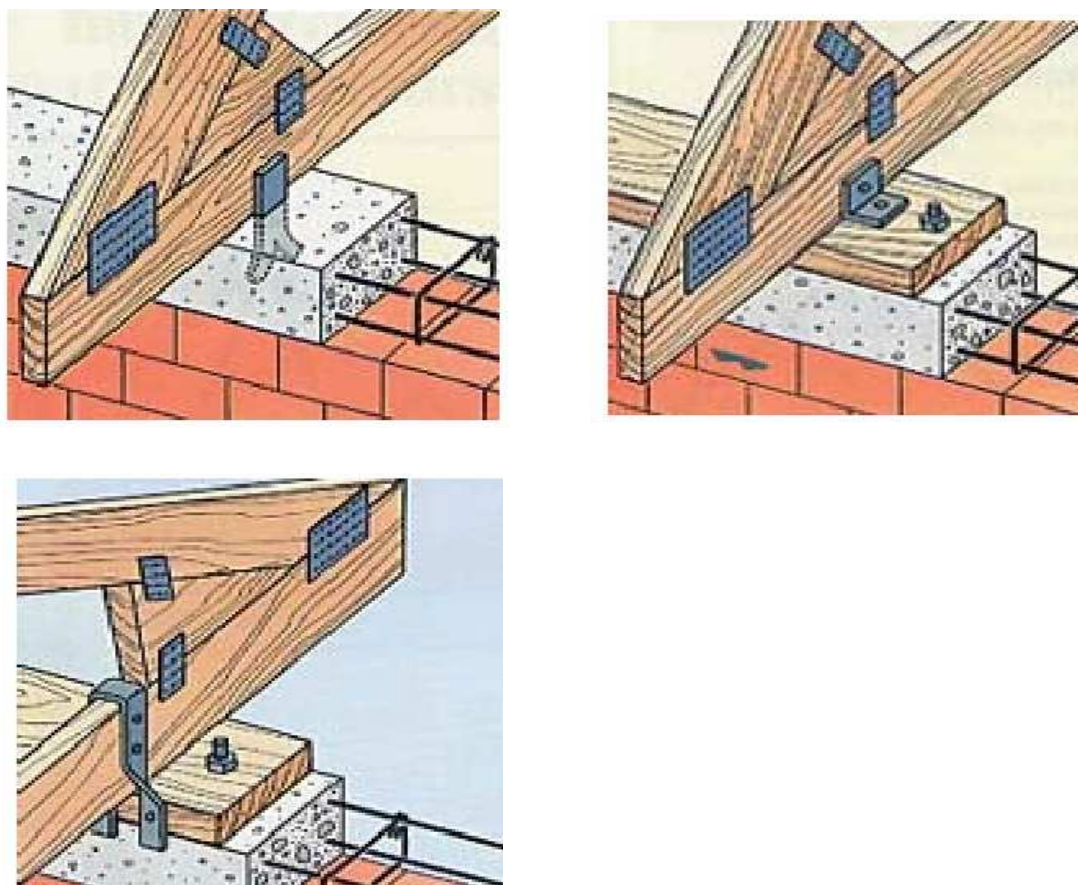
Exemples de fixations de support de couverture (ici des fermettes en bois) au gros-œuvre.
